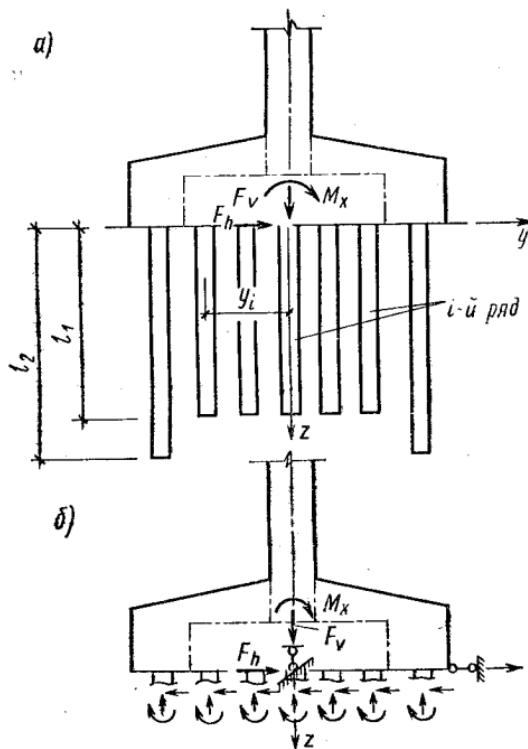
Модель расчета усиленного свайного фундамента:
